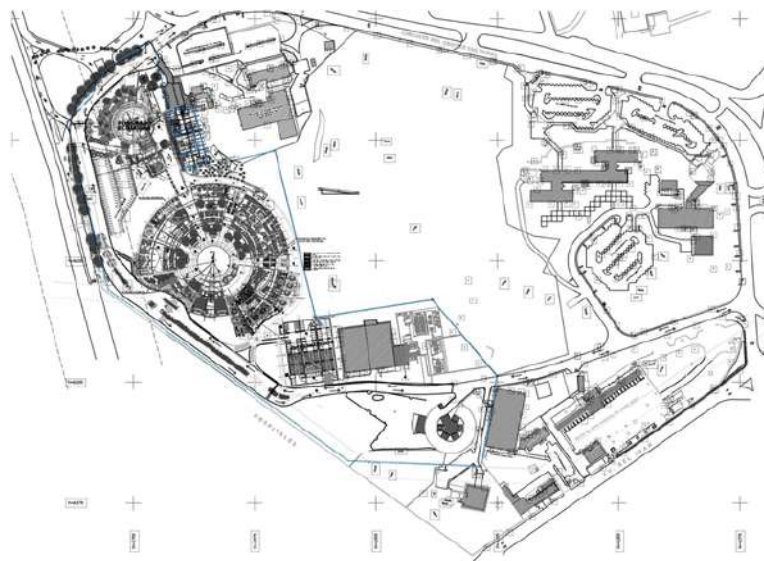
Planta de Conjunto Unidad de Posgrados UNAM.
